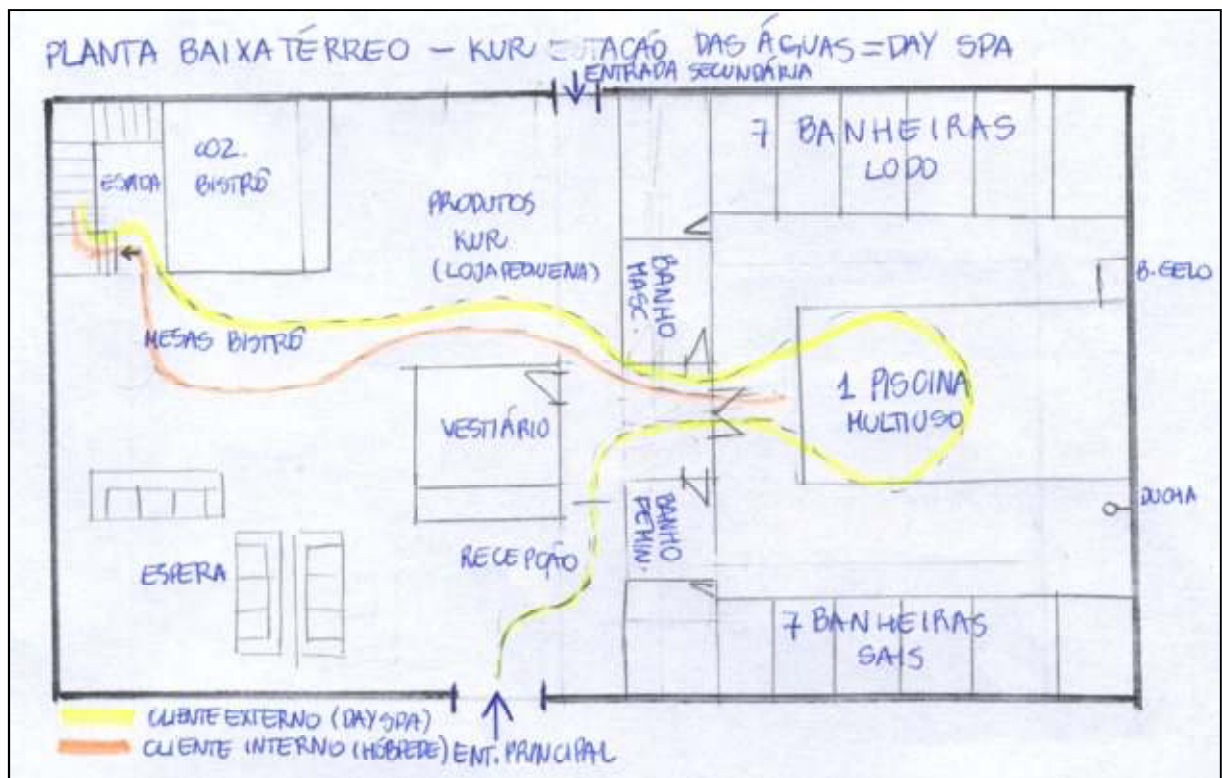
Croqui esquemático da planta baixo do térreo do Day Spa – estação das Águas. Fonte: autora (2011)
